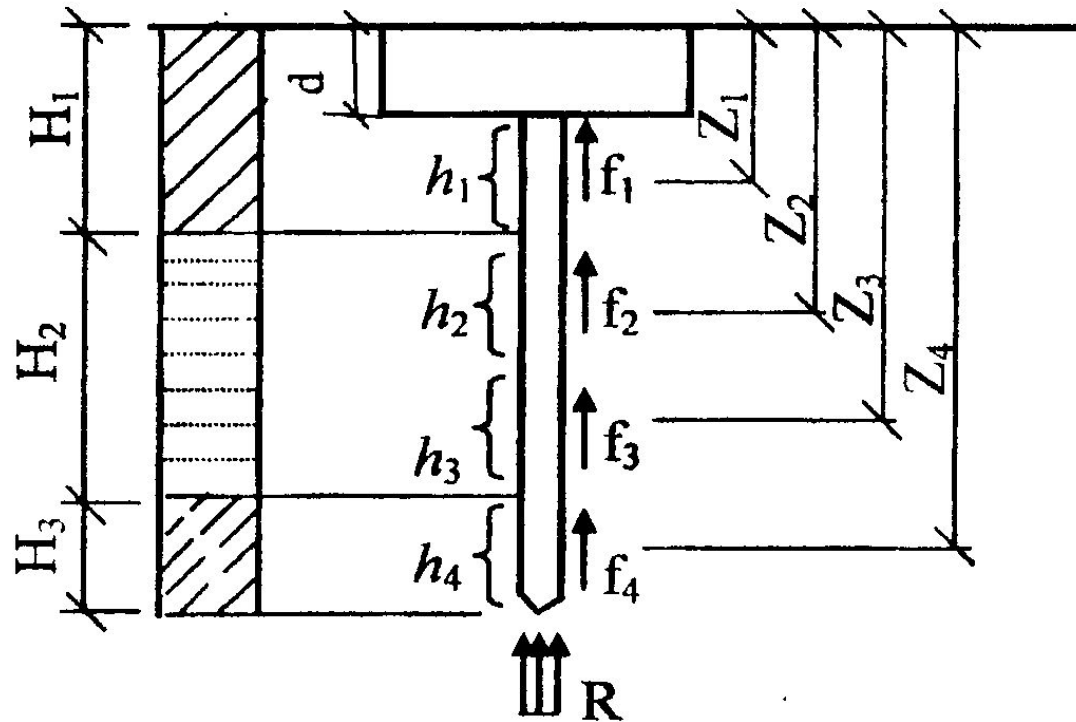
Схемы передачи нагрузки на грунт основания:
